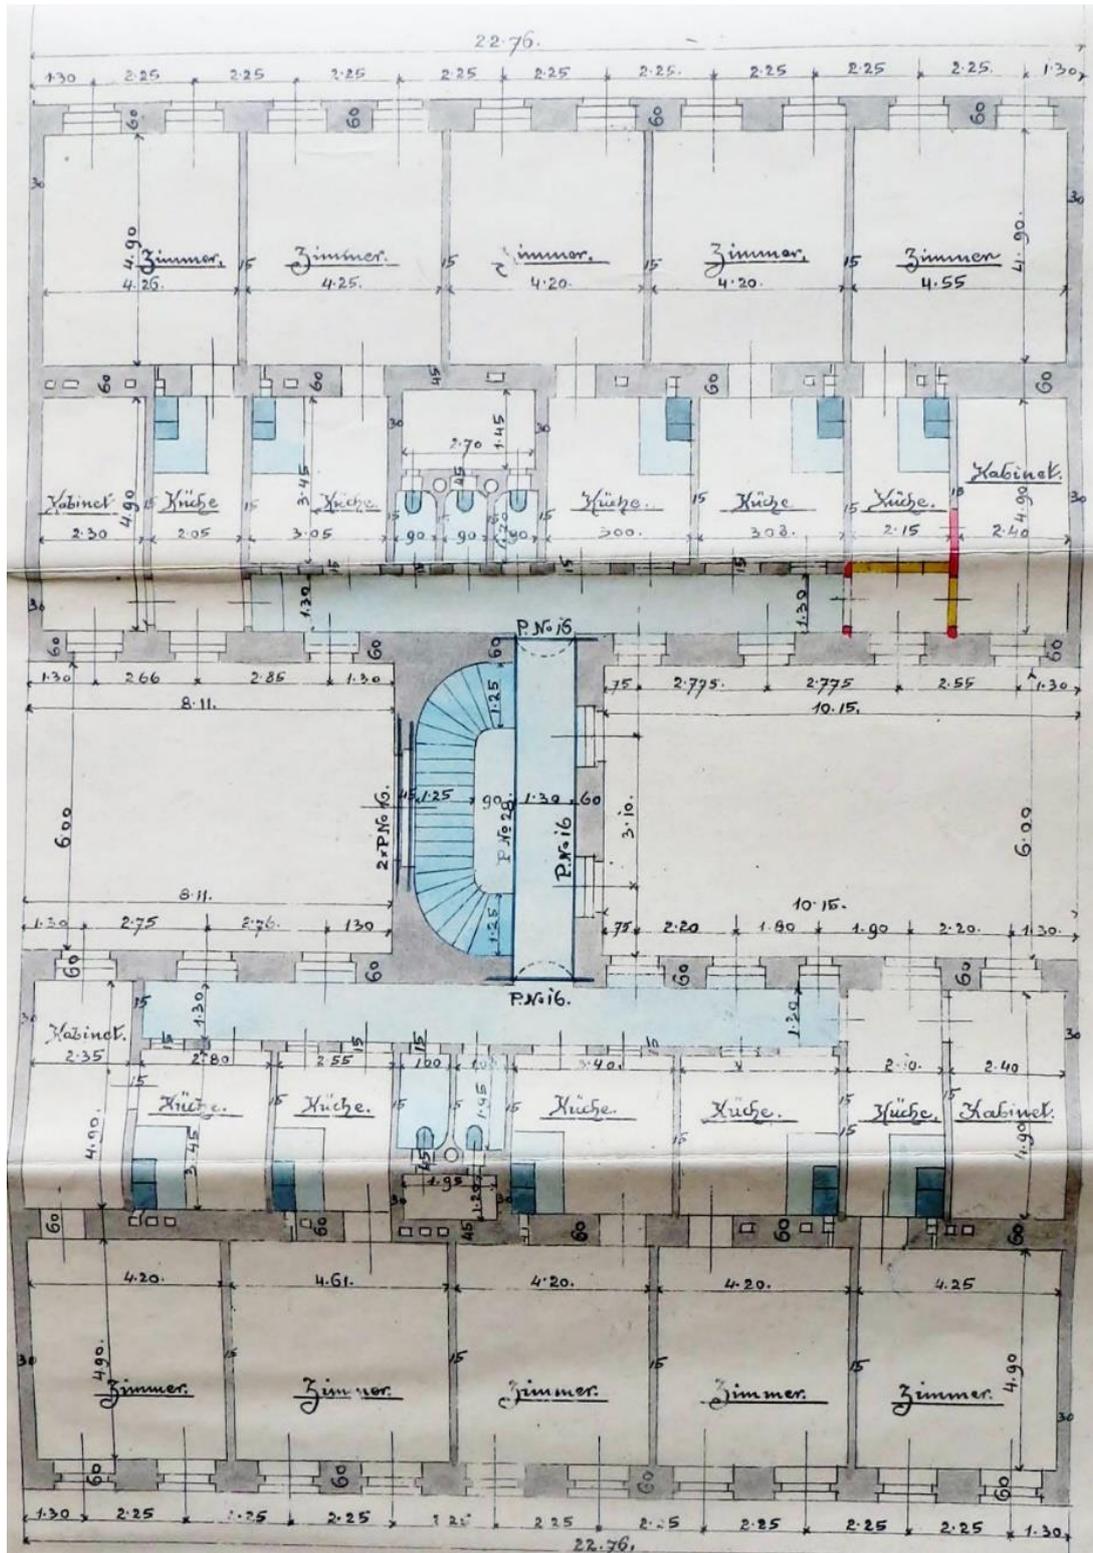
Auswechslungsplan 1906, 1. – 3. Obergeschoss, Vorgartenstr. 67, 1200 Wien
